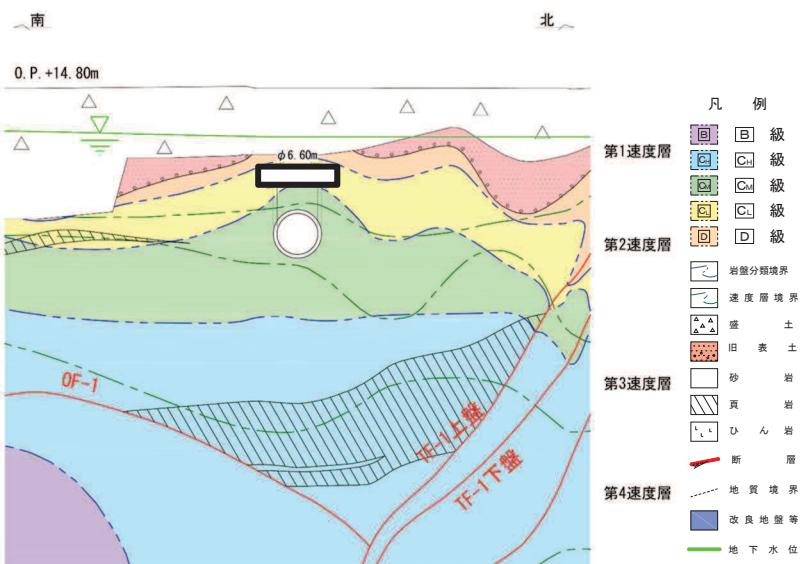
排気筒連絡ダクト（岩盤部）地質断面図（B-B 断面）
